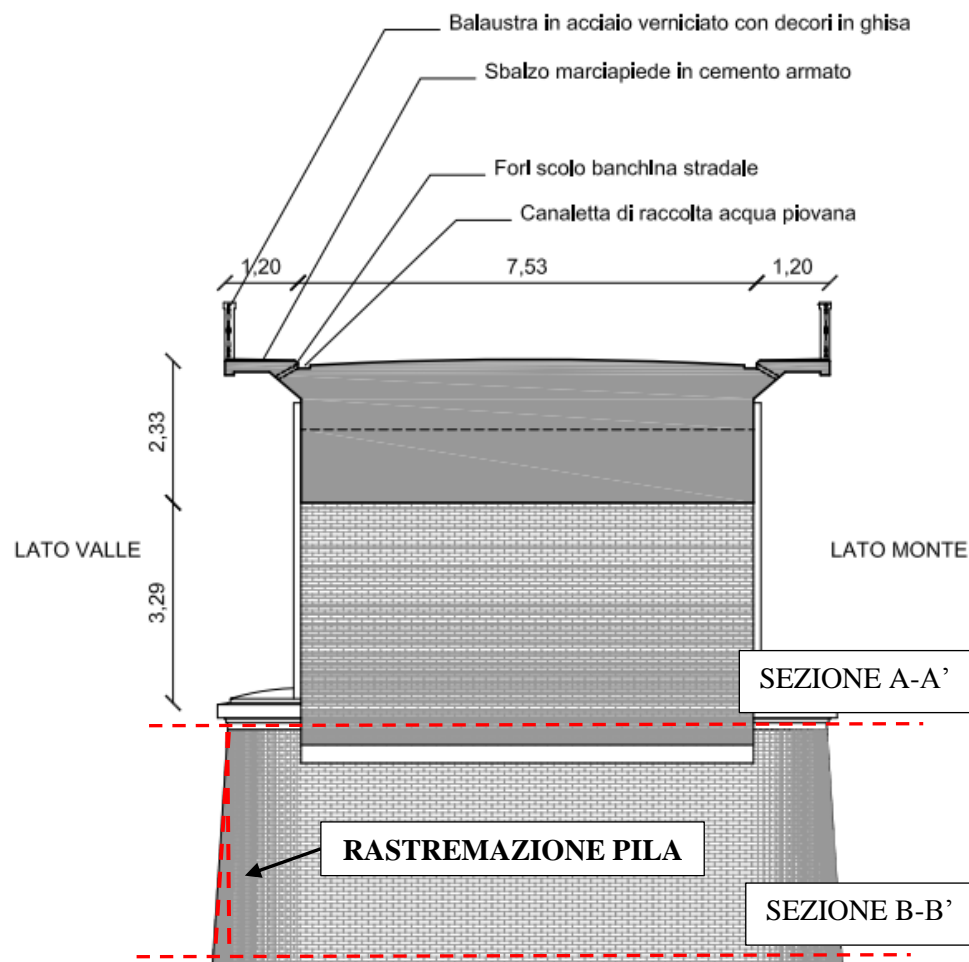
Sezione rastremata della pila da planimetrie e sezione pervenute.
